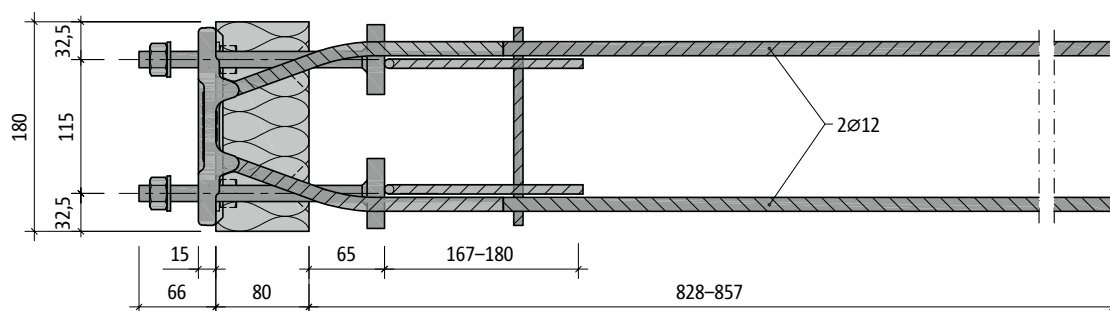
Schöck Isokorb® T type SQ-V3 : vue en plan
